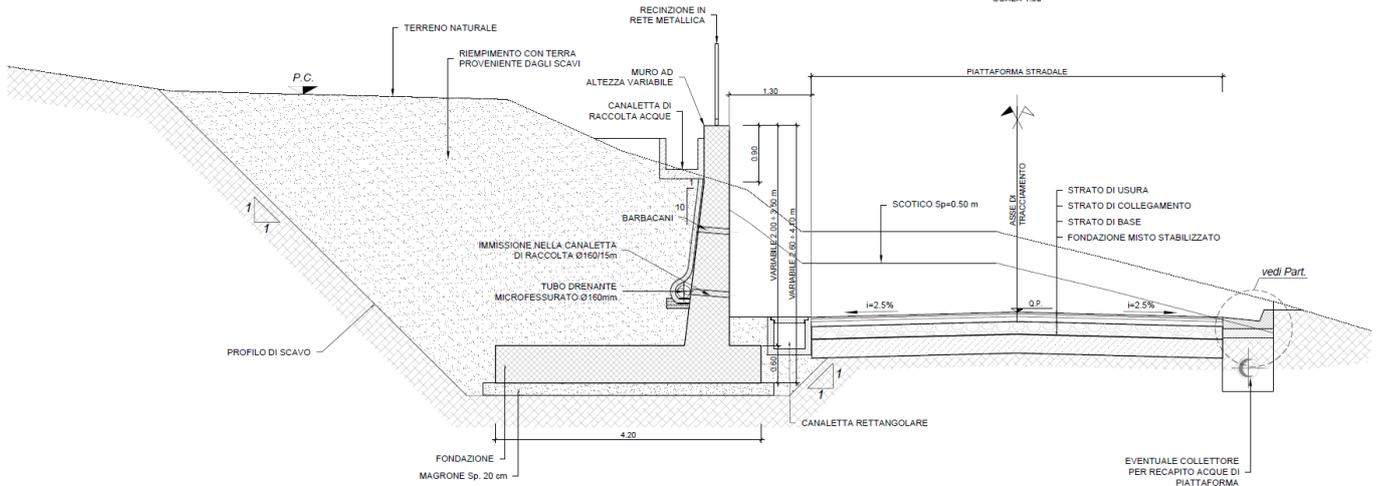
Sezione tipo in trincea con muro di controripa (tipo 1)
